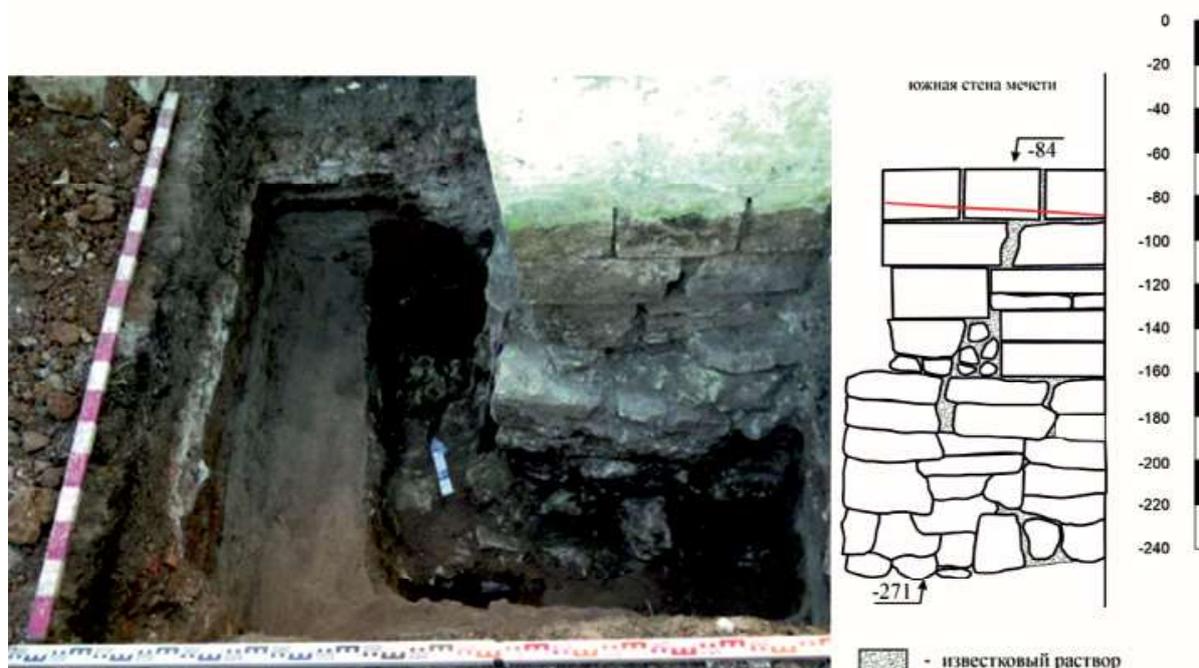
Шурф № 5(18) 2020 г. южная стена мечети и фундамент.
